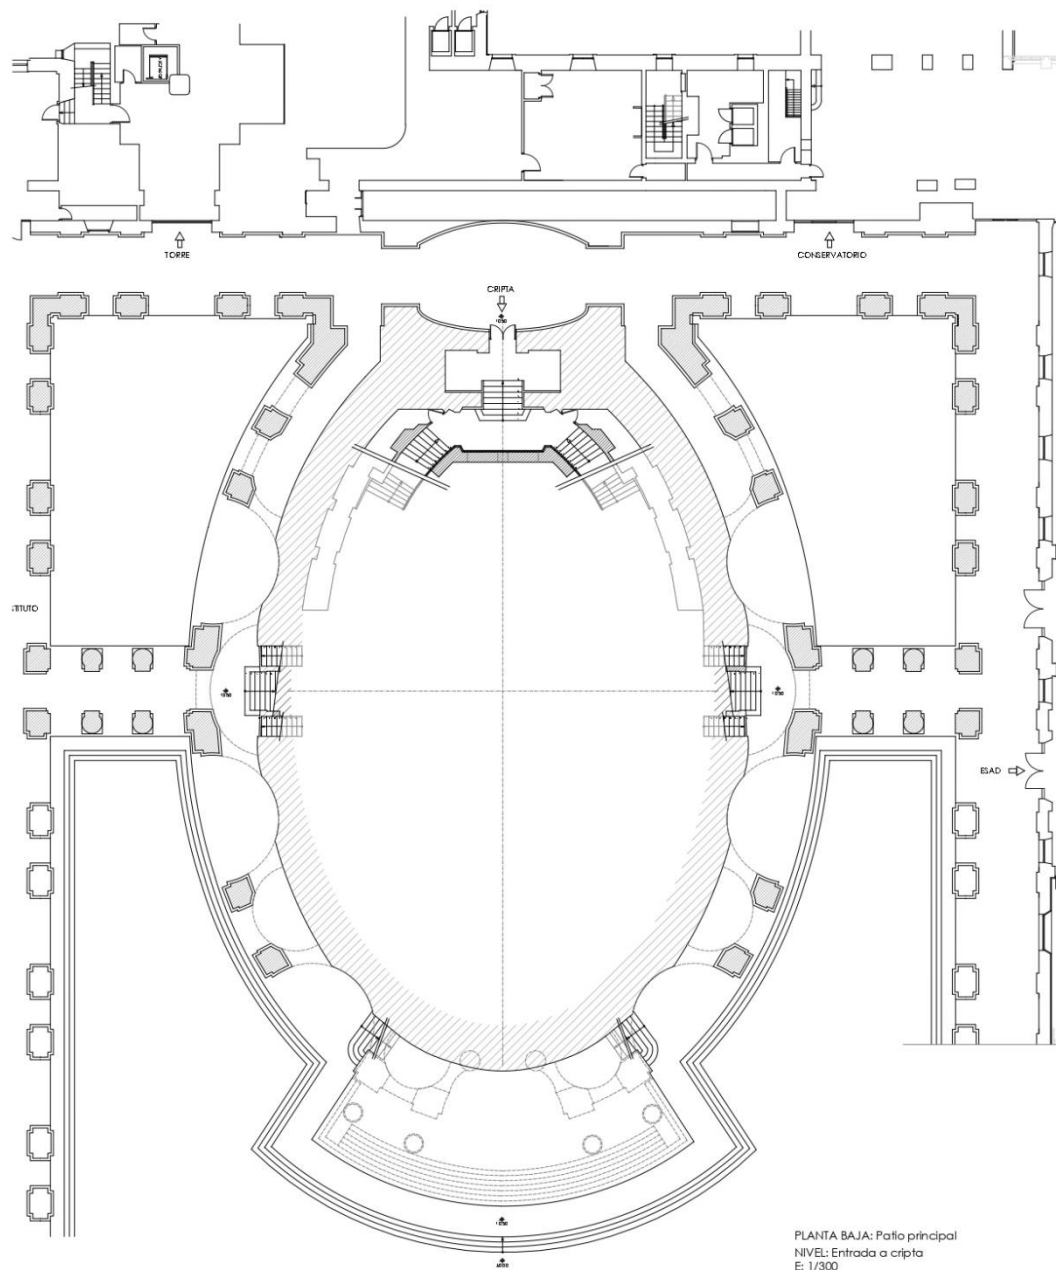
Planta baja, patio principal, nivel de entrada a la cripta.
